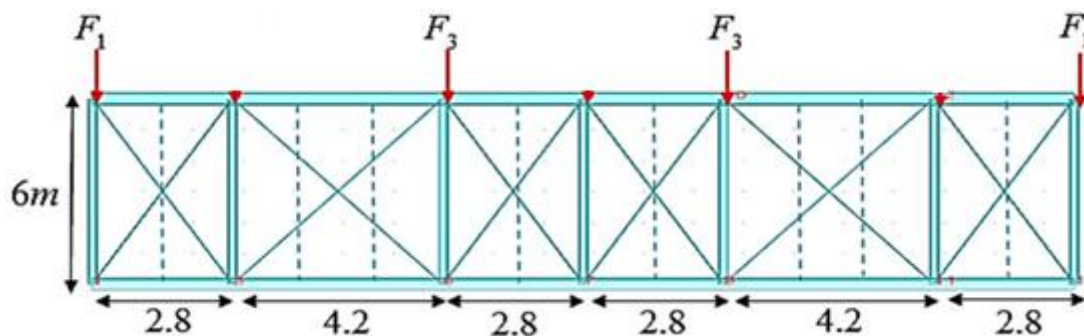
schéma statique de la poutre au vent en pignon.
